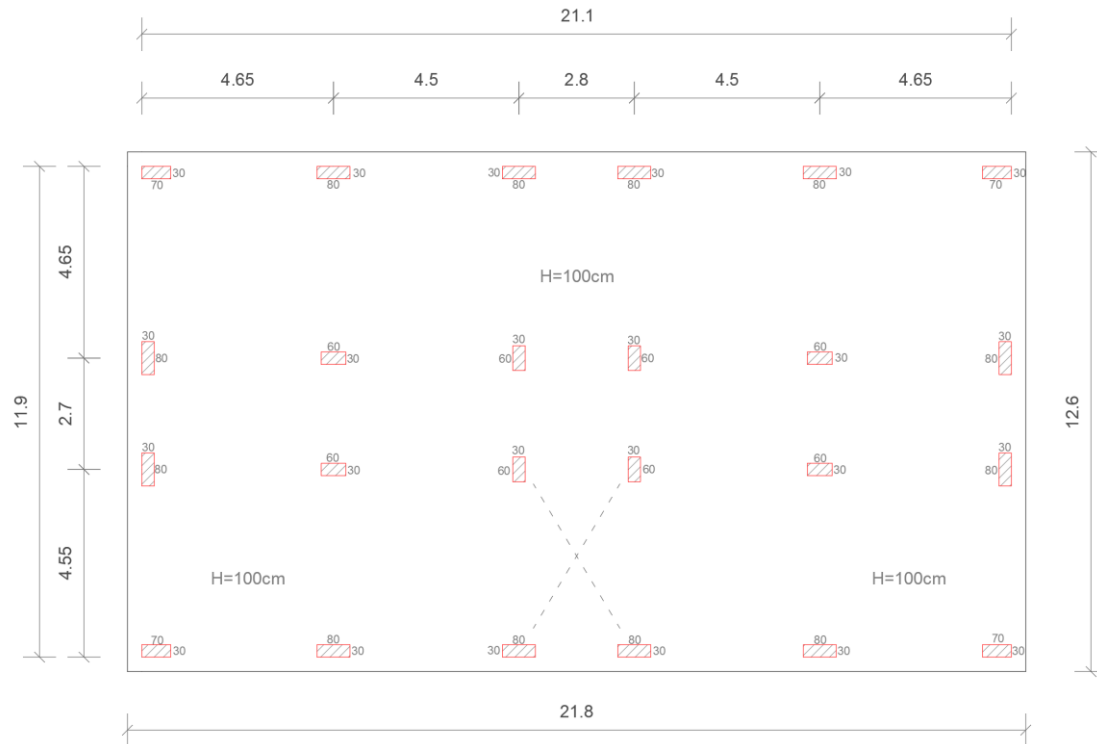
Carpenteria struttura in c.a. a due piani con platea di fondazione.
